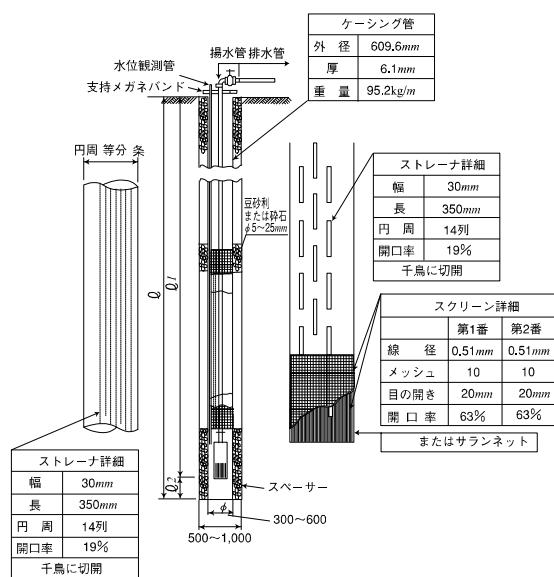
ディープウェル断面図の例 (社団法人 日本ウェルポイント協会)
